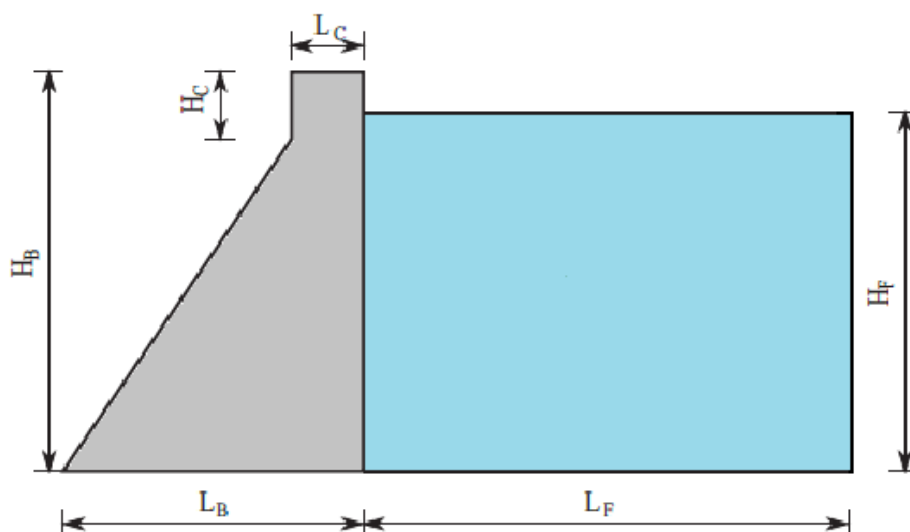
Profil type du barrage de l'Oued Fodda
